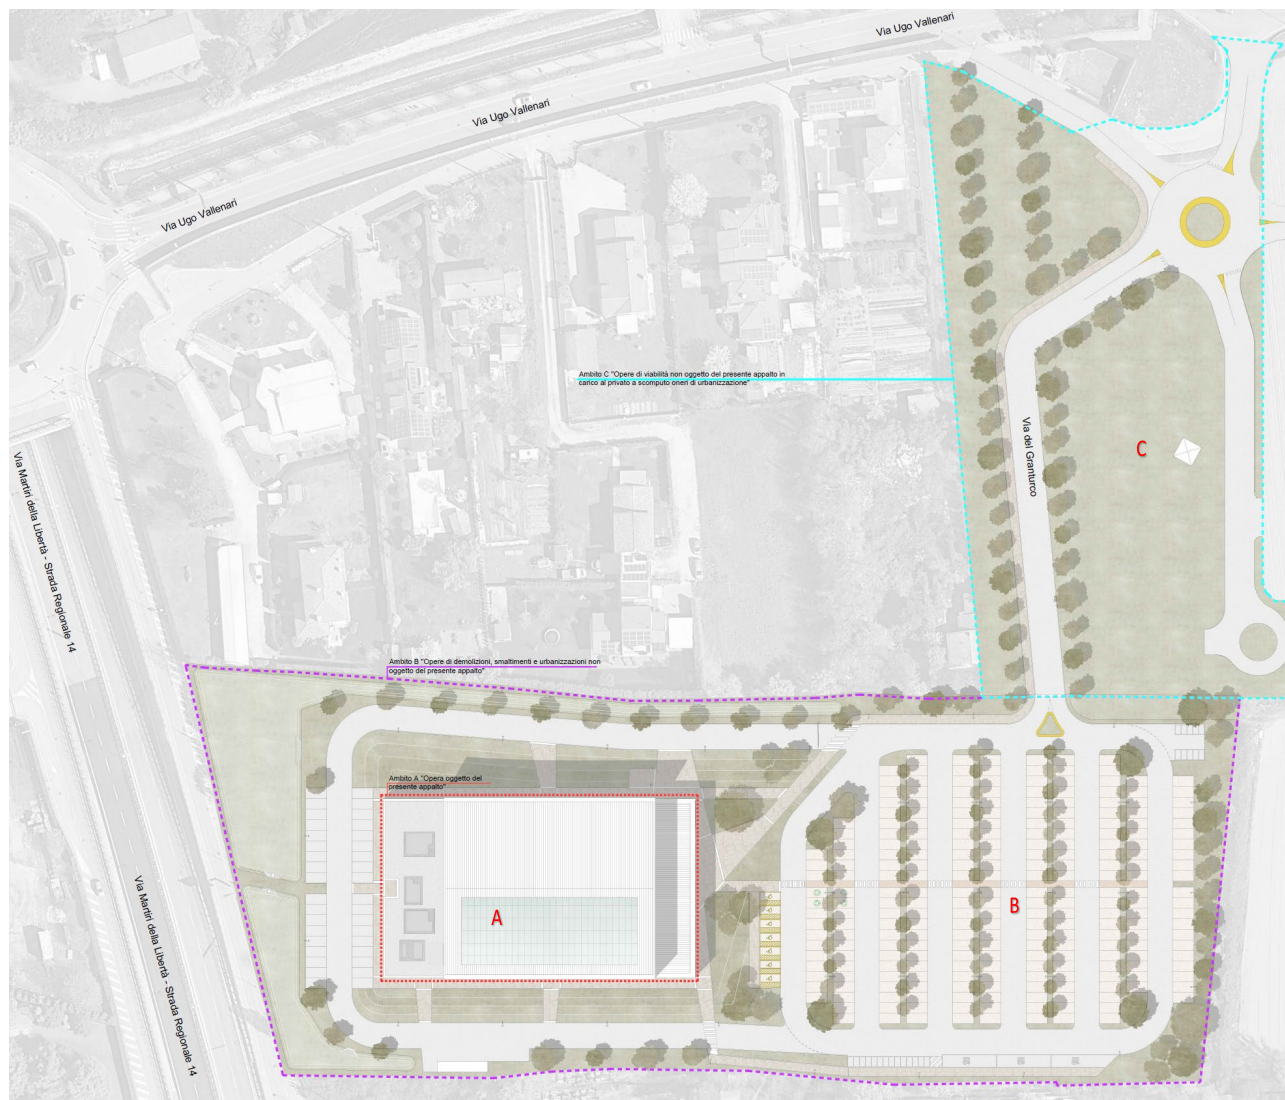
planimetria d'insieme con individuazione degli ambiti di intervento
